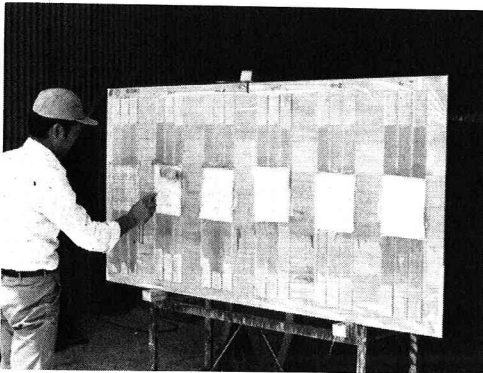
接合作業状況 (接合作業面の状態: 鉛直)
